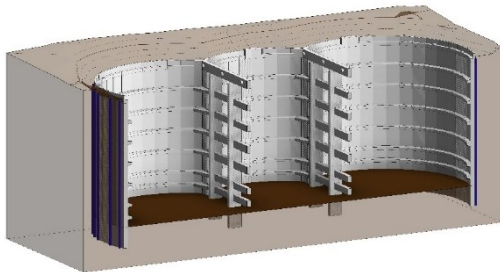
Corte longitudinal da estrutura do reservatório após toda a escavação do interior e execução dos anéis e estroncas.
